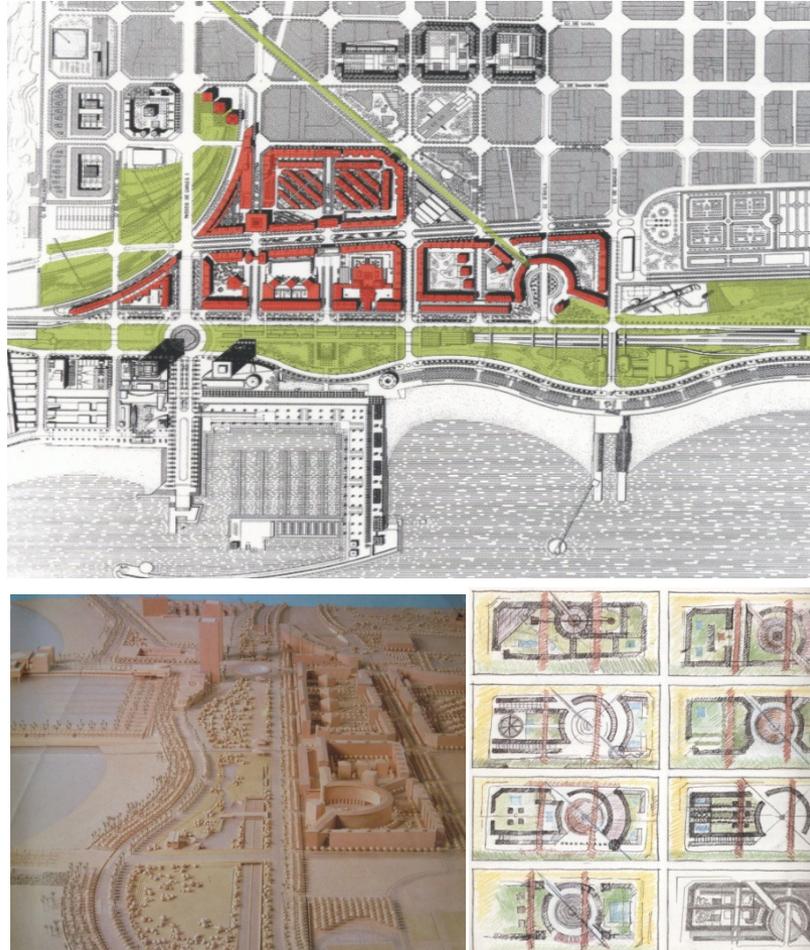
MBM Arquitects y Albert Puigdoménech, Villa Olimpica, 1986-1992. Planimetria generale dell'area, maquette e schizzi preparatori del progetto
